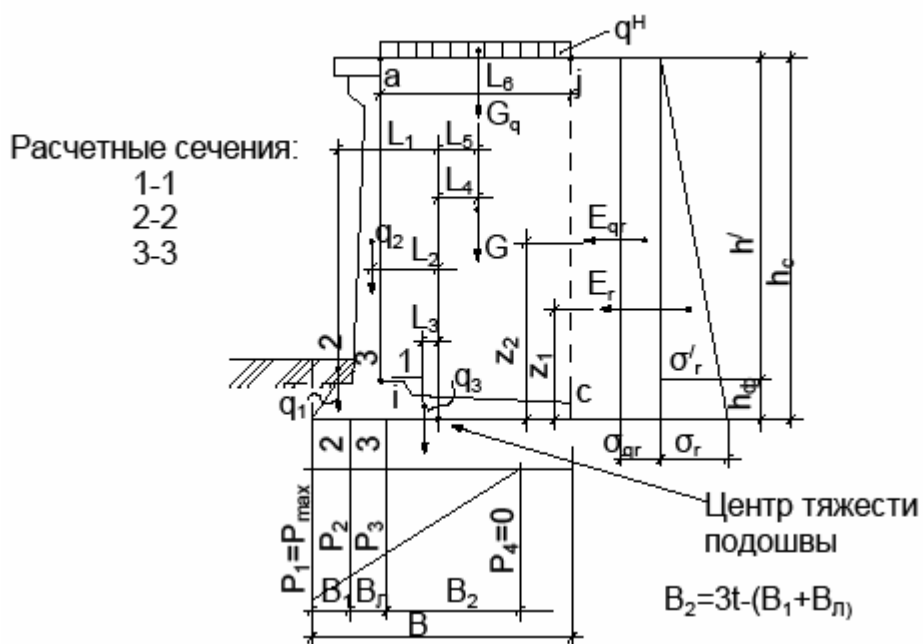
Расчетная схема угловой подпорной стены при расчете ее на прочность
